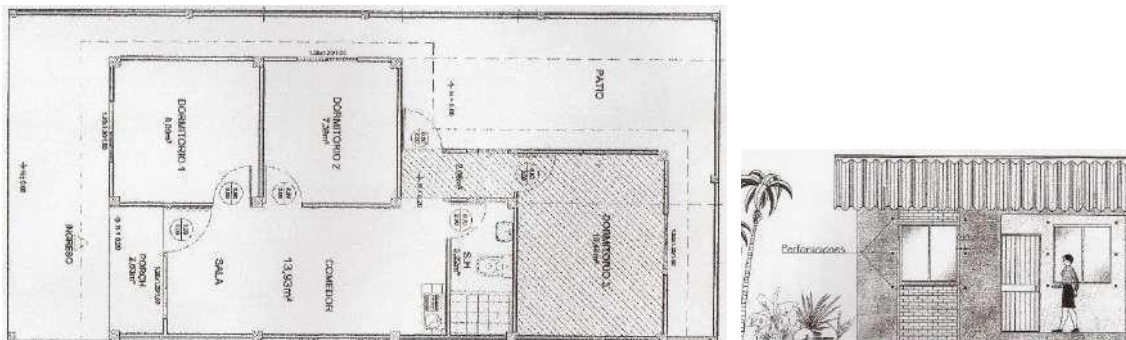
Proyecto Arquitectónico, planta y elevación frontal
